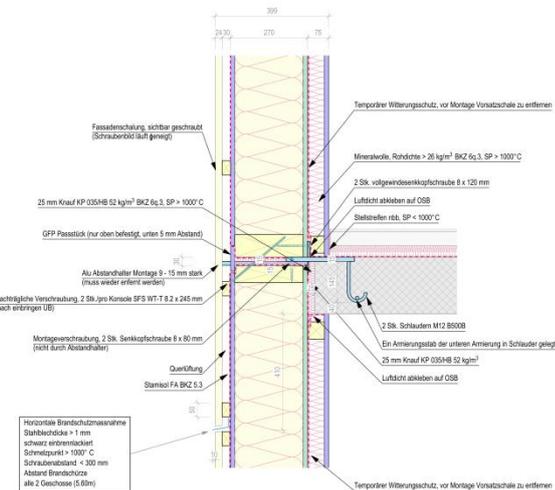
Hybridbau mit nicht tragenden Aussenwandelementen in Holzbauweise; Aussenwände in Holzbauweise parallel zum Stahlbetonbau hochgezogen [2]
